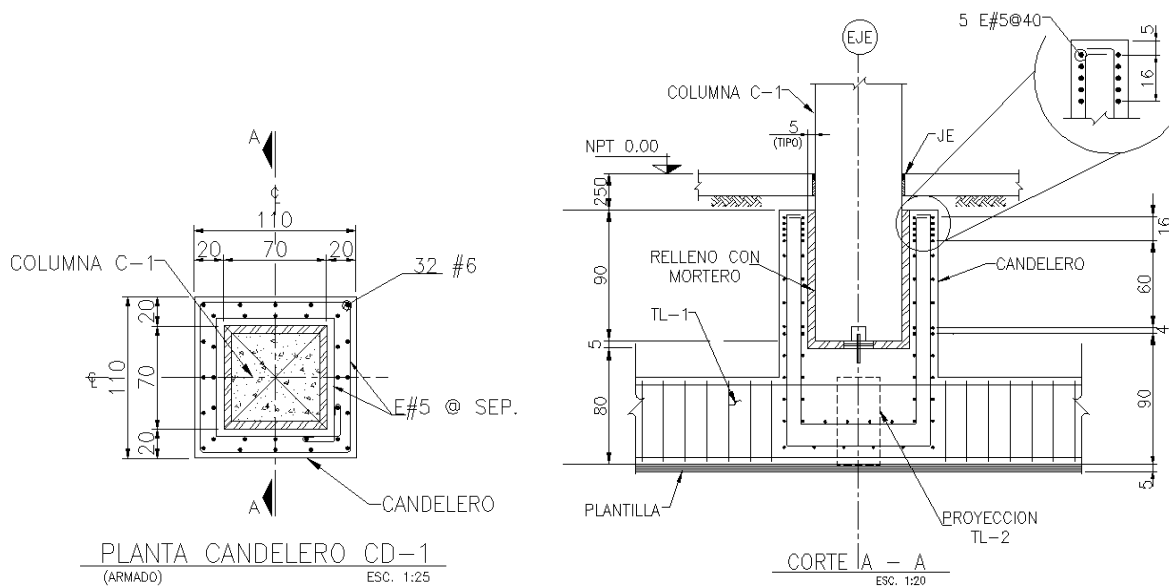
Habilitado de refuerzo en trabes de liga y candeleros para la cimentación de un Rack
